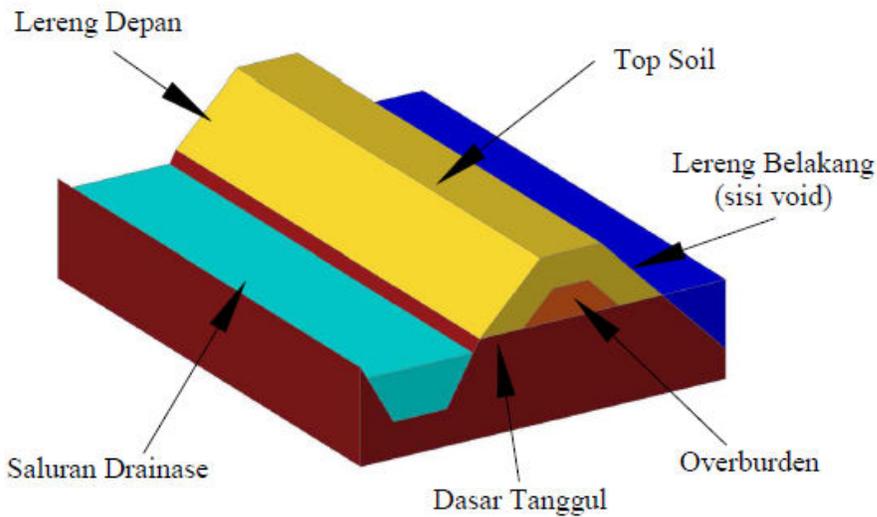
Rancangan Desain Drainase Pit K1-1 dengan skala 1:20
